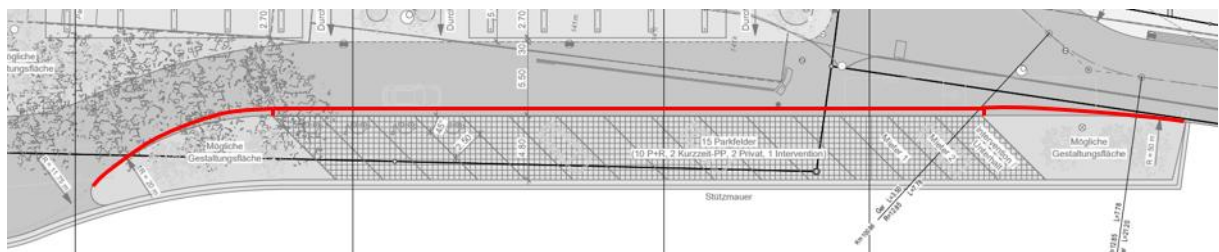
Planausschnitt Plan Nr. 25809-001; Ergänzung Vorschlag Sicherheitsabstand Parkierung in Rot
